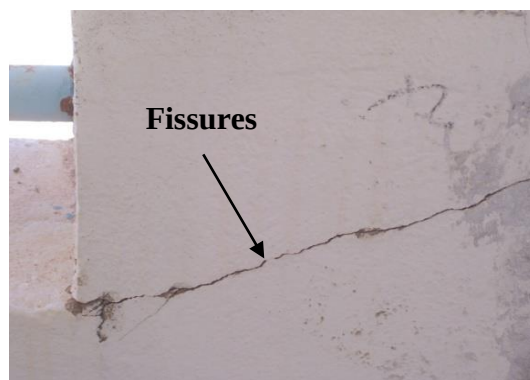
fissuration des colonnes de bâtiment au niveau de premier étage.
